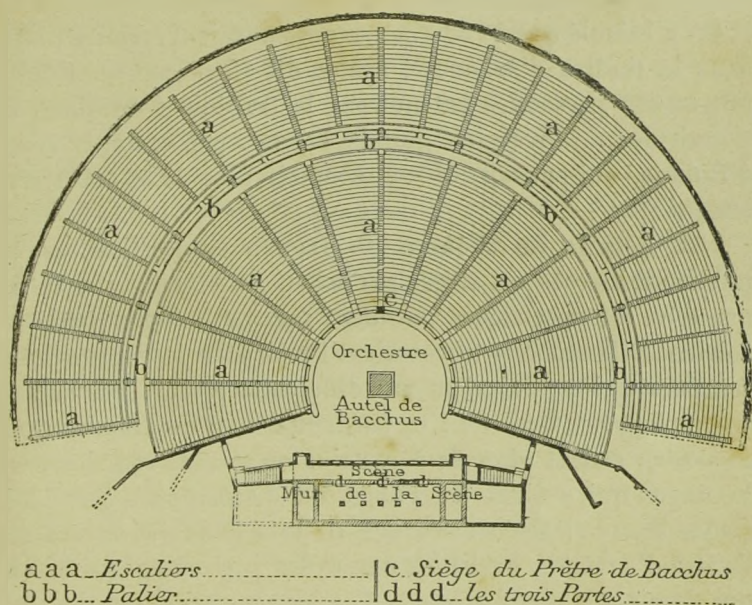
Plan du théâtre d'Épidaure (restauré).
